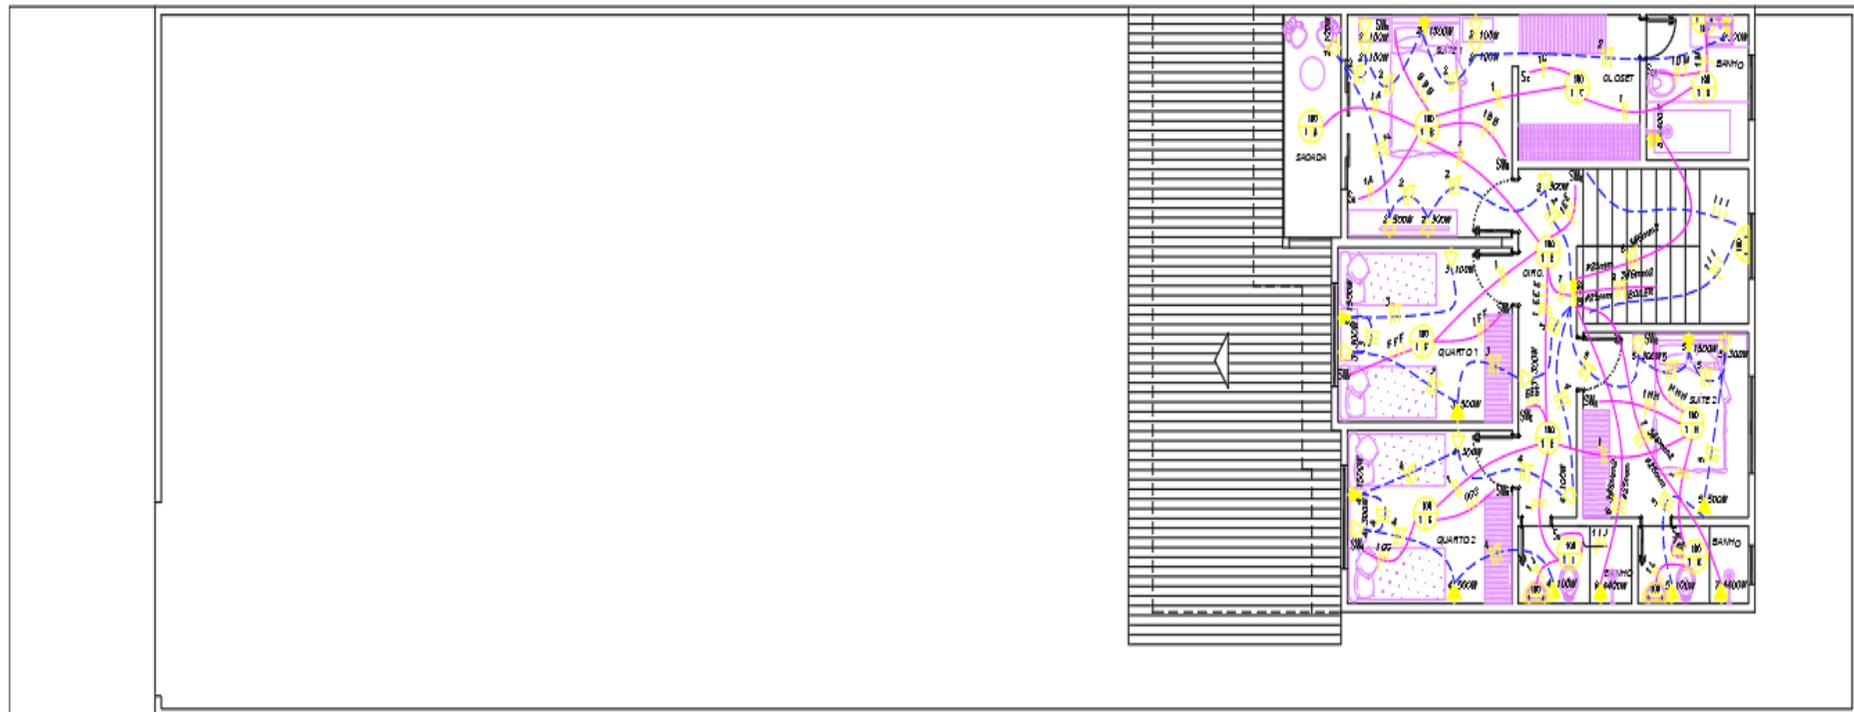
Planta Pavimento Térreo Projeto Elétrico
